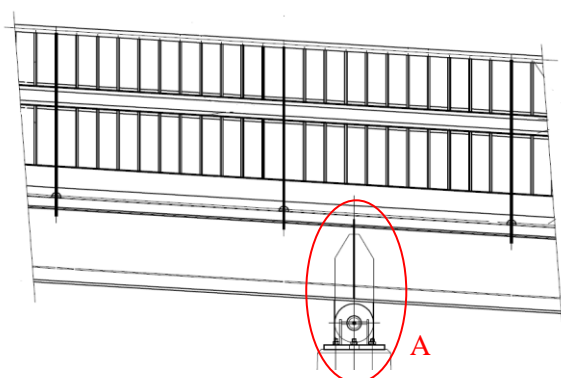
Corte longitudinal do tabuleiro concebido com viga caixão, na zona dos pilares [24].
